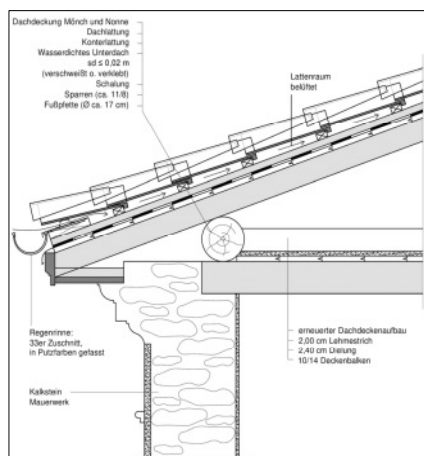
Geplanter Aufbau der Dachhaut Villa Vigoni, Verfasser
